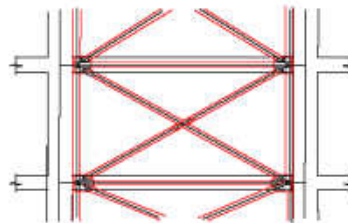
Esquema de Refuerzo Diagonales Metálicas de Fachada
